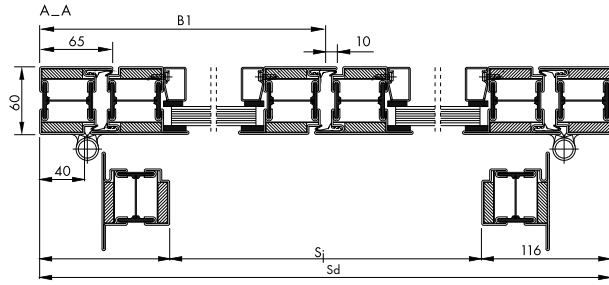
Coupe horizontale d'une porte coupe-feu à un battant EI 30.
